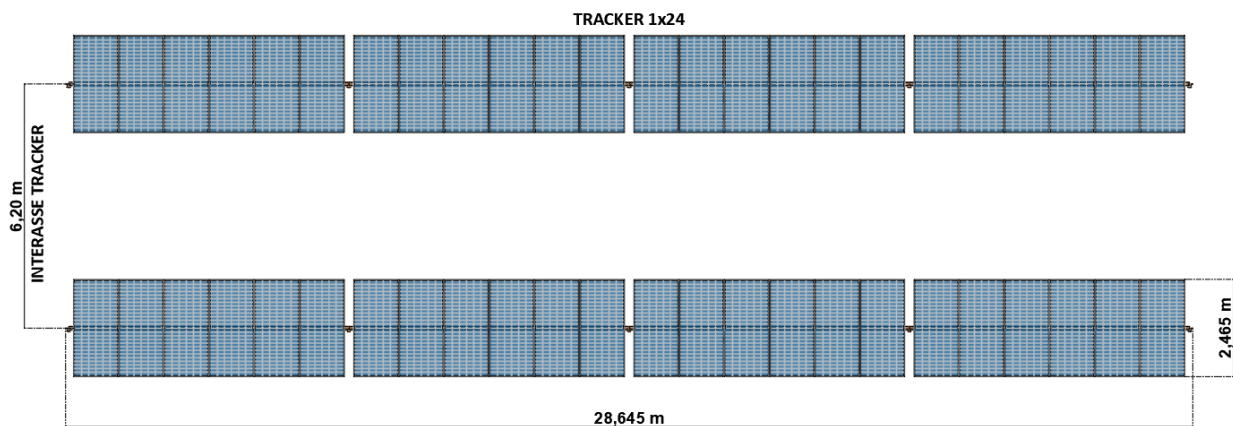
Vista in Pianta delle strutture (c.d. tracker)
